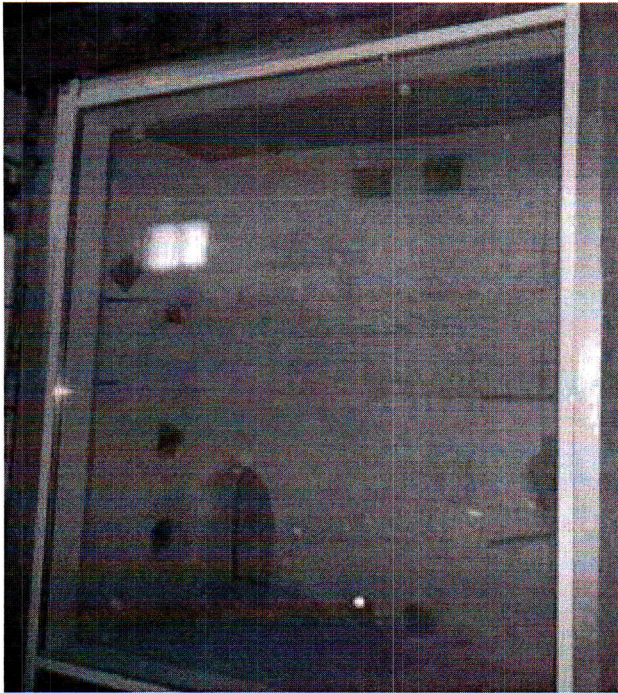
Образец светопрозрачной ограждающей конструкции до испытаний.
